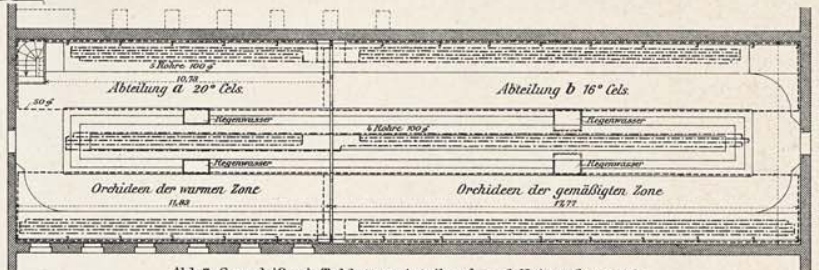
Grundriß mit Tabletteneinteilung und Heizung. 1:200.
